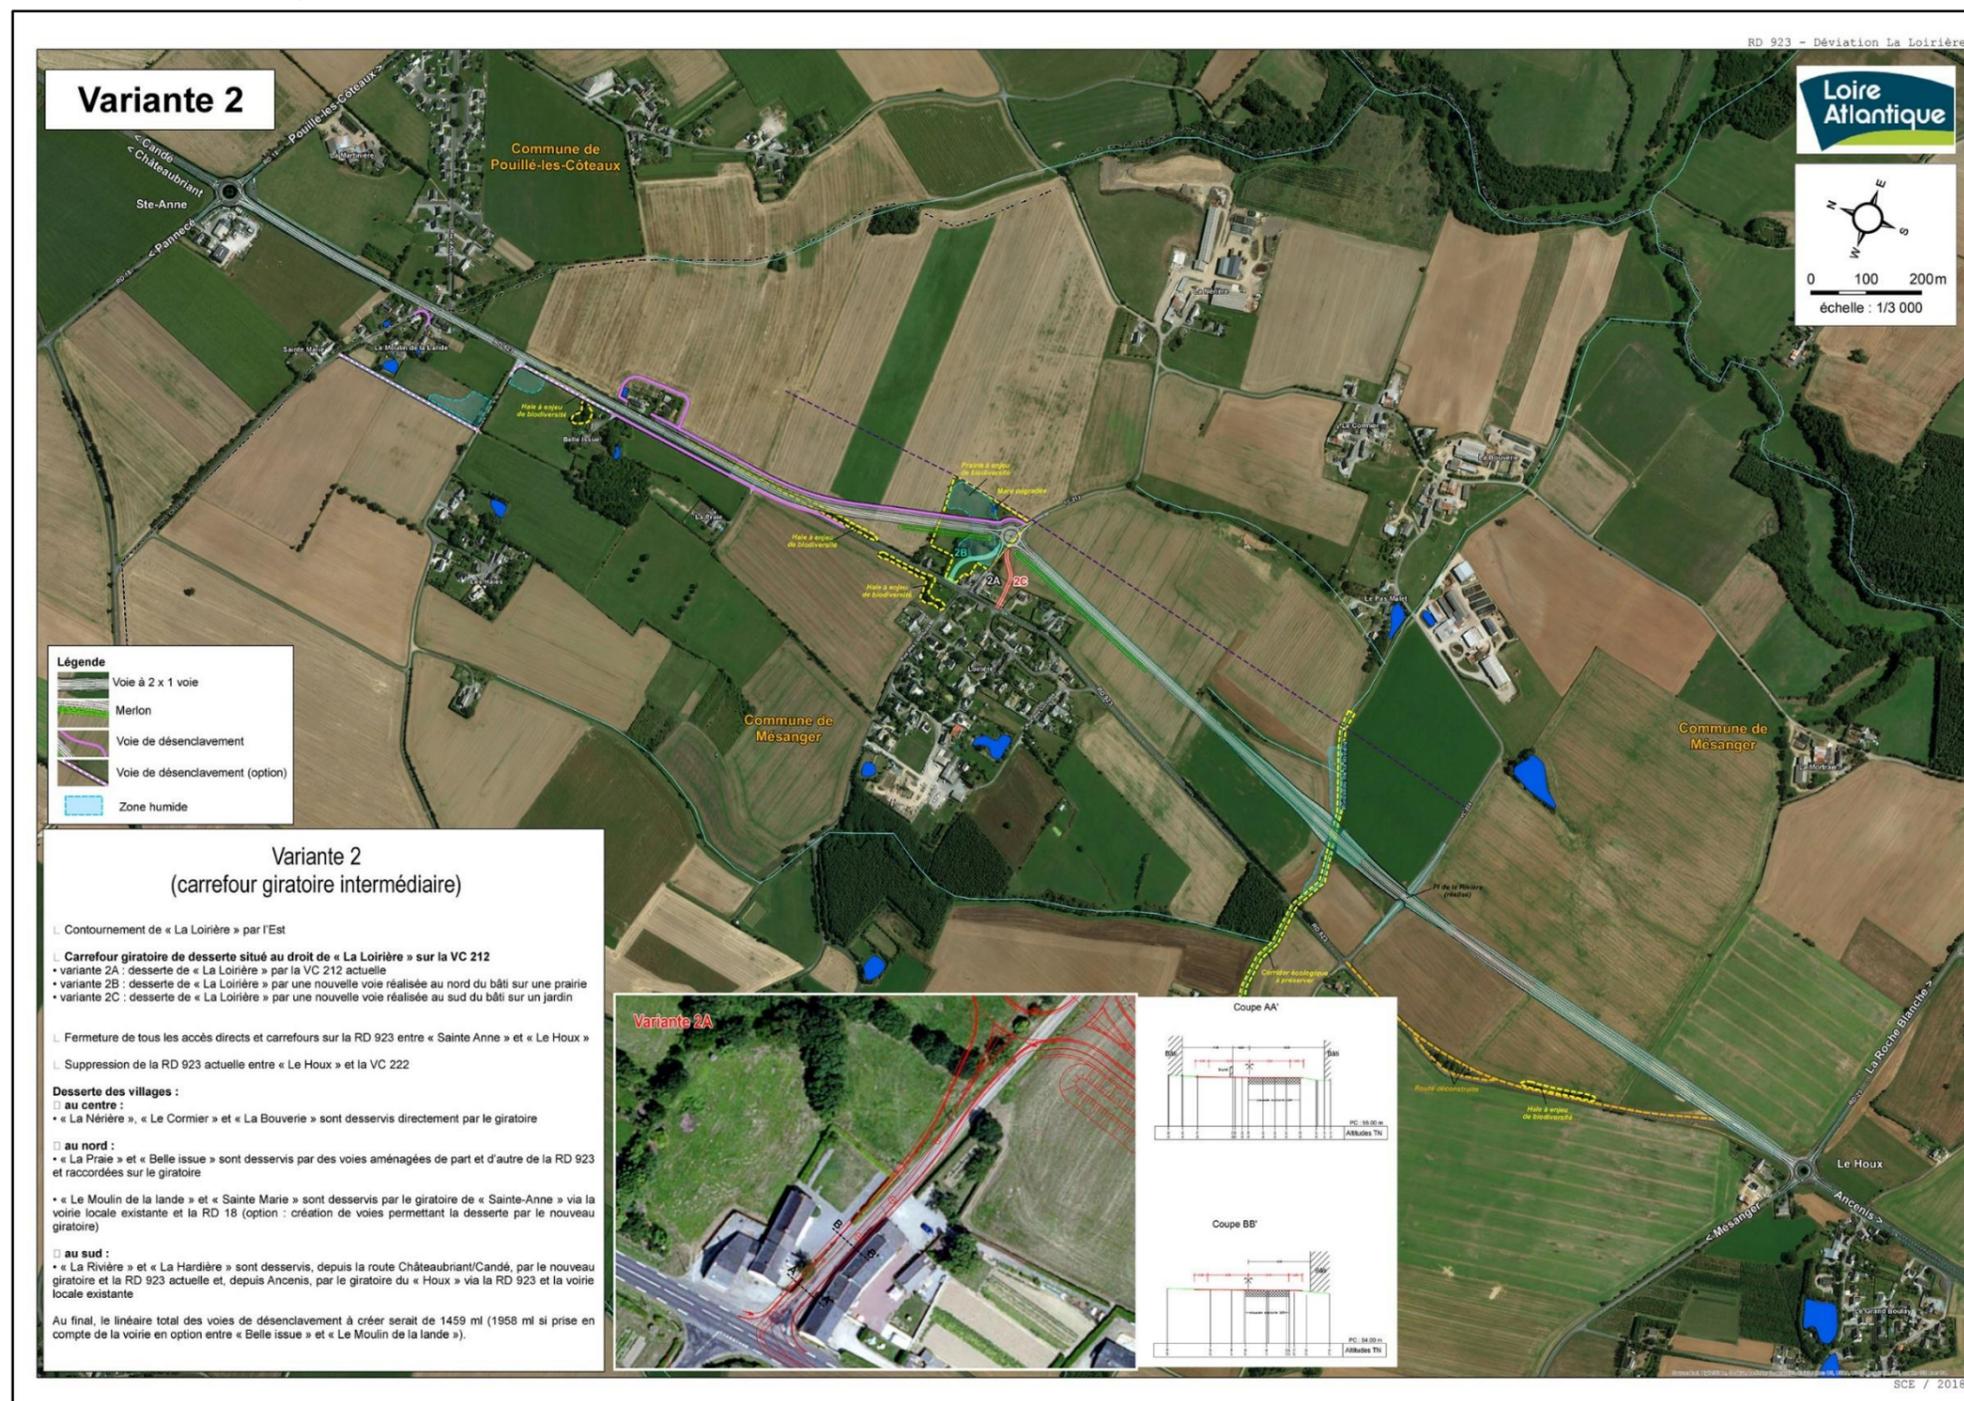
Plan de la variante 2 (carrefour giratoire intermédiaire)
